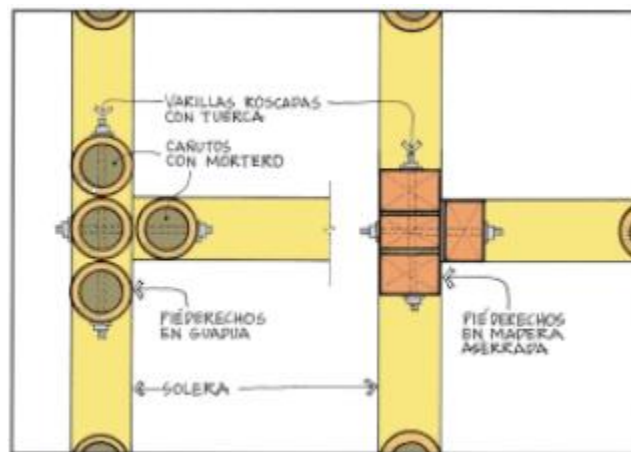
Unión de dos muros con pie derecho de Guadua en el mismo plano.
